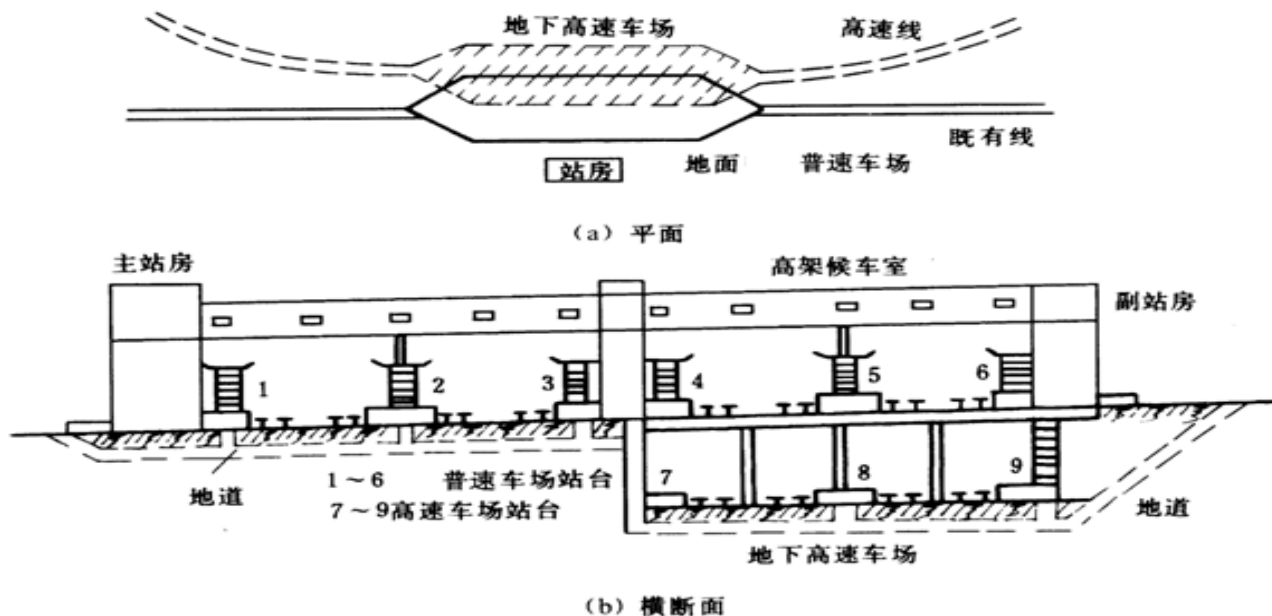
既有站下方设地下高速车场平面、横断面布置图
